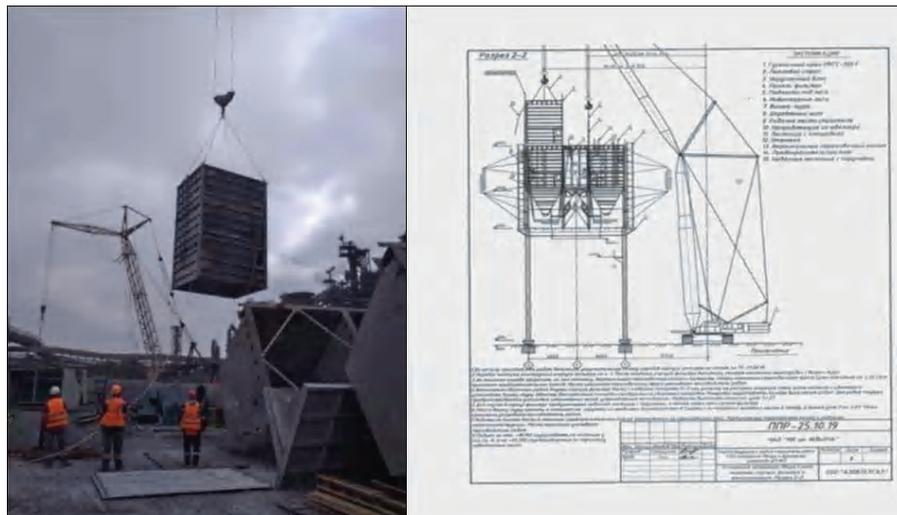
Подъем металлоконструкций монтажных блоков стен корпуса фильтра.
